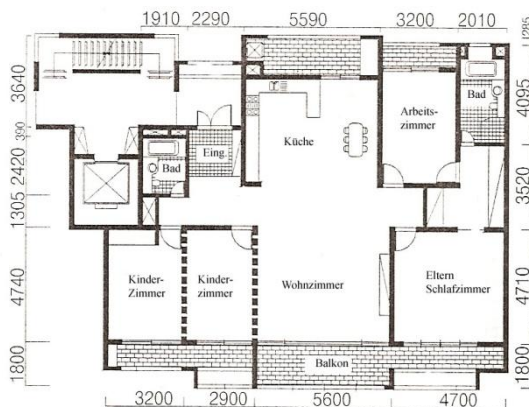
Grundriss der Mok-Dong-Wohnhochhaus-Siedlung mit einer Wohnungsgröße von 156m²
